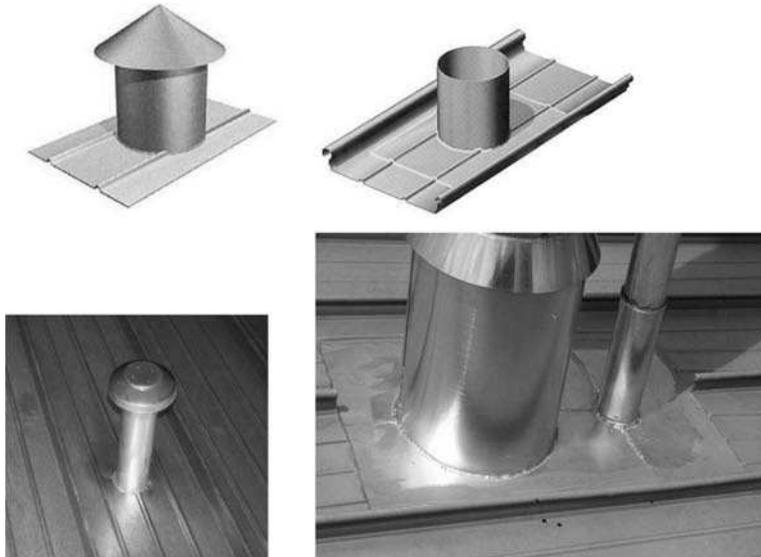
Eingeschweißte Rohrdurchführung bei Stehfalzprofildeckungen aus Aluminium
